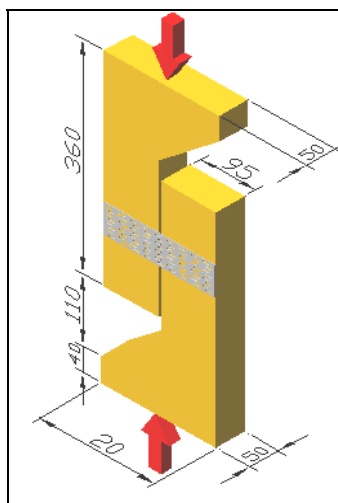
Dimensões das peças (mm): ensaio de arrancamento paralelo às fibras
